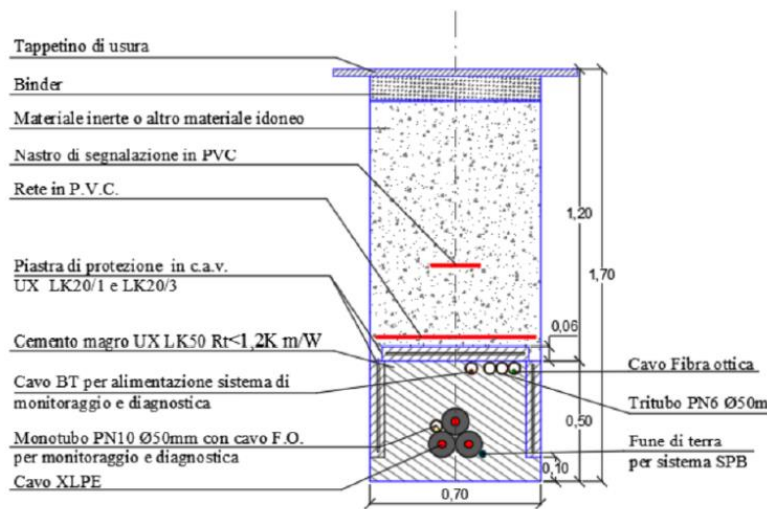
Sezione di posa cavidotto AT su Strada Asfaltata
